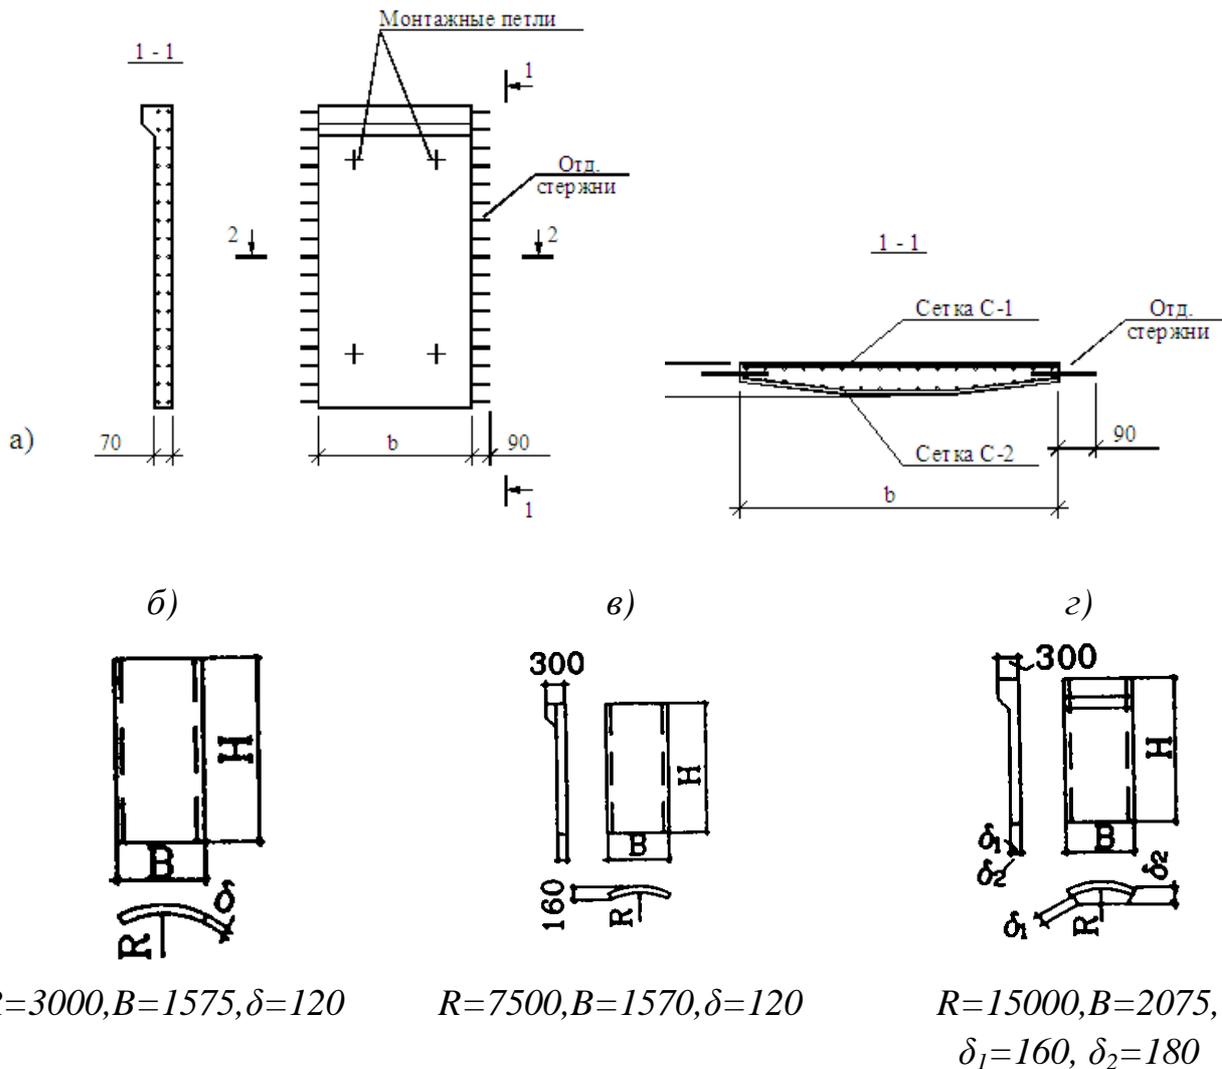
Стеновая панель цилиндрического резервуара (а – общий вид и армирование); варианты решений типовых панелей ПСЦ (б-г).
